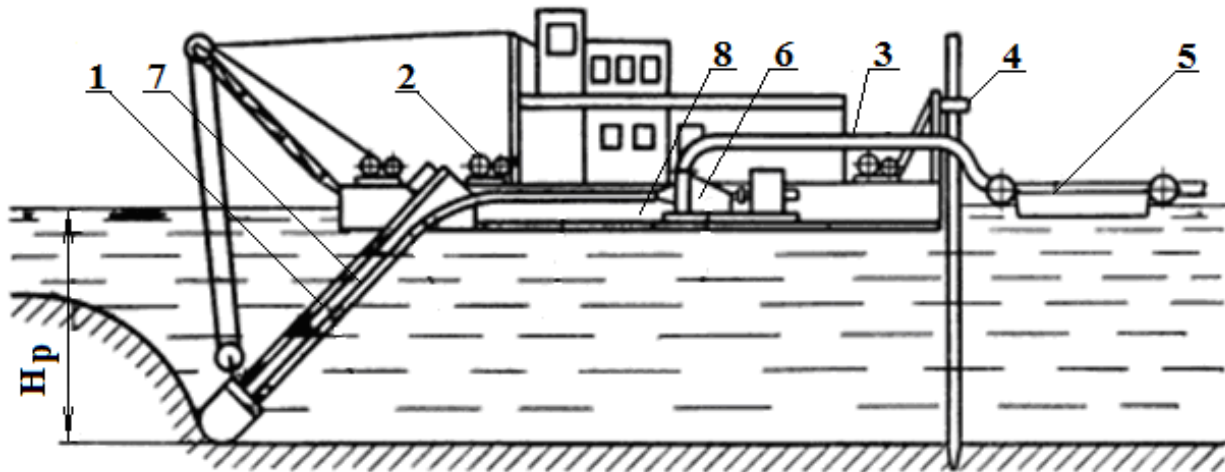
Конструктивна схема землесосного снаряда: 1 – ґрунтозаборний пристрій; 2 – лебідка; 3 – напірний пульпопровід; 4 – пальовий хід; 5 – плавучий пульпопровід; 6 – ґрунтовий насос; 7 – всмоктувальний трубопровід; 8 – понтон
